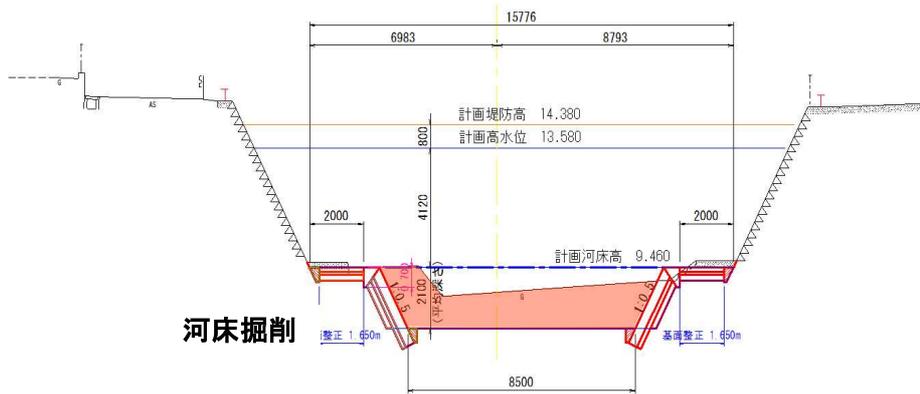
上流掘削区間の代表断面 標準断面図 (3.938km)
